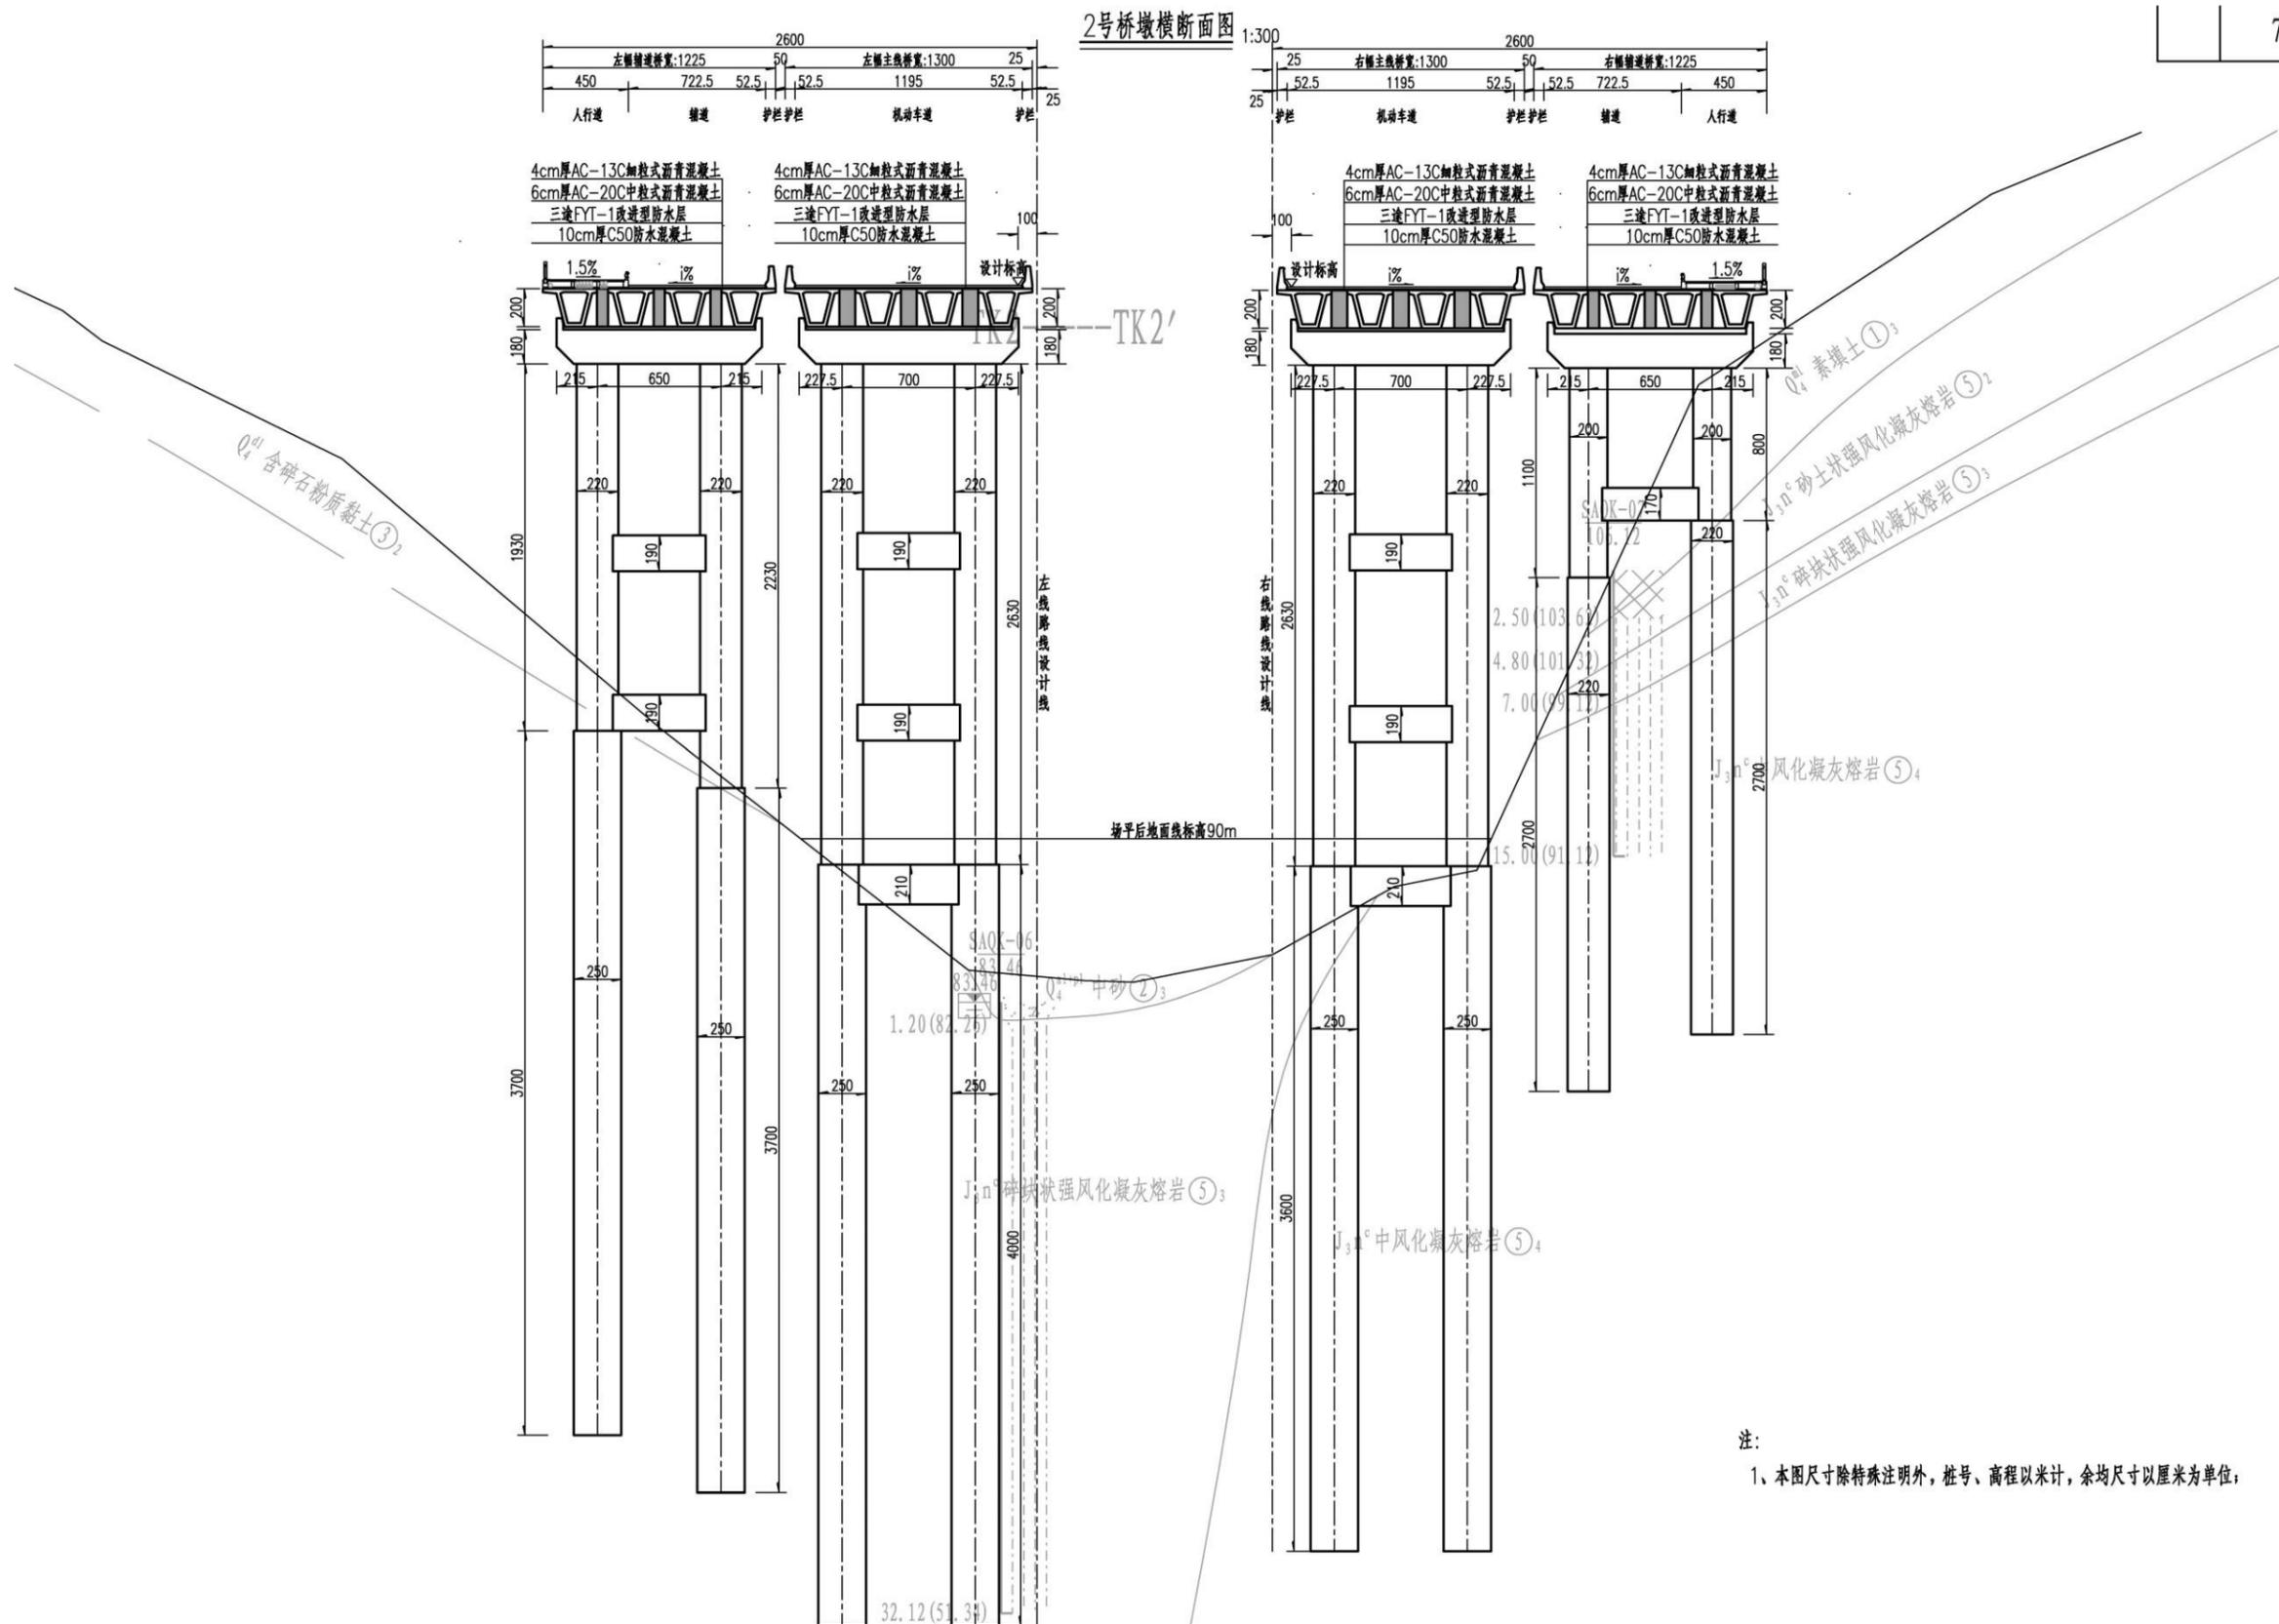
本项目炭坑溪大桥 2#桥墩横断面图
